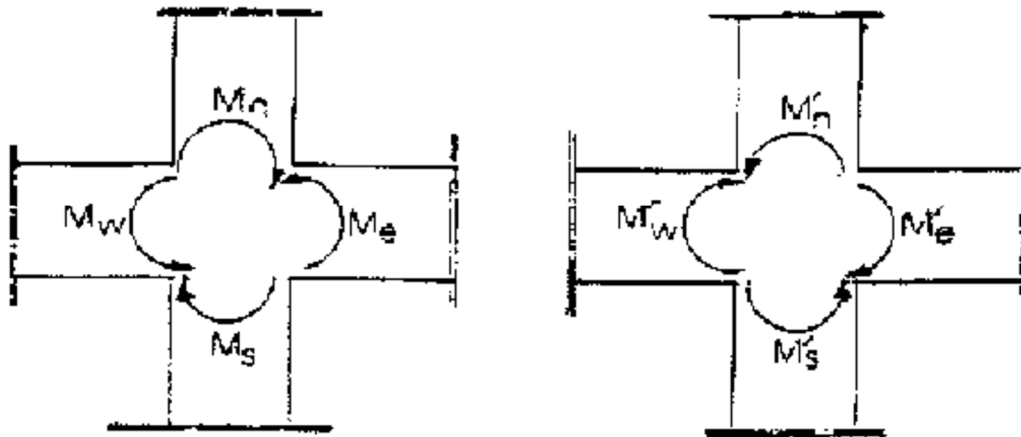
Dimensionnement d'un nœud poutre-poteau
